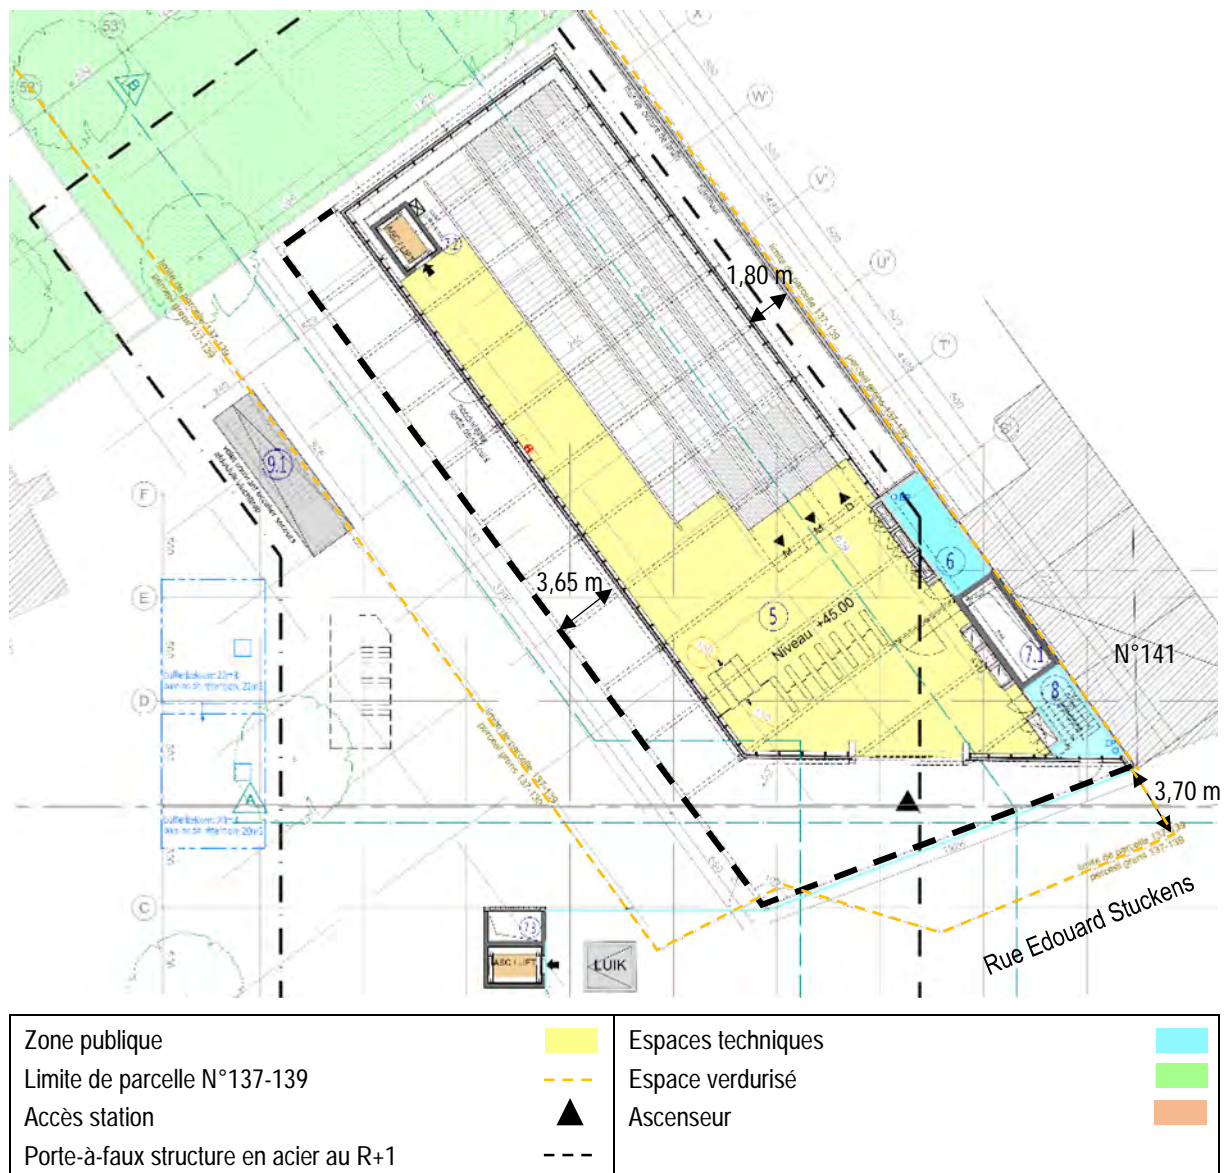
Plan du rez-de-chaussée de la station (ARIES sur fond BMN, 2018)
